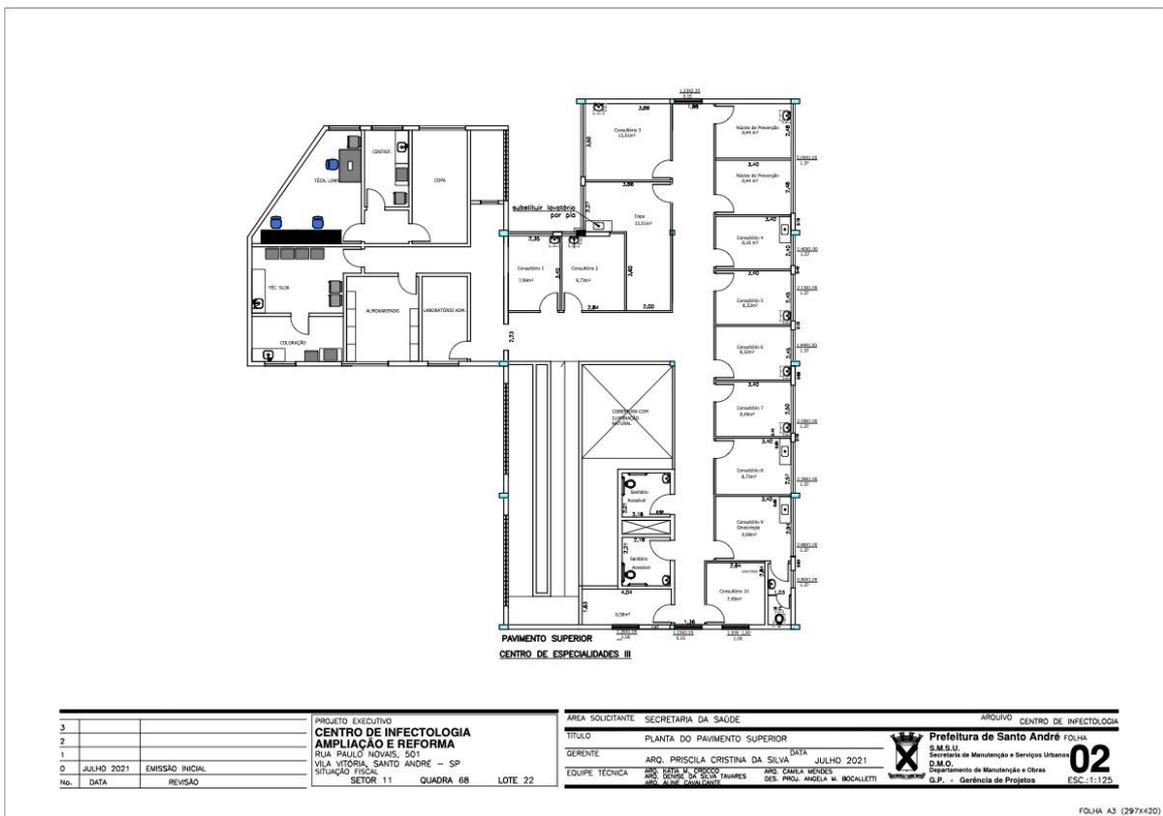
Centro de Infectologia de Santo André. Planta do pavimento superior
